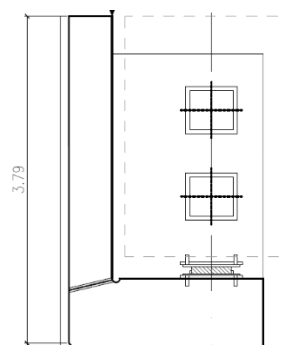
Alzado lateral de estribo como neoprenos de recentrado (Carlos Fernandez Casado)
